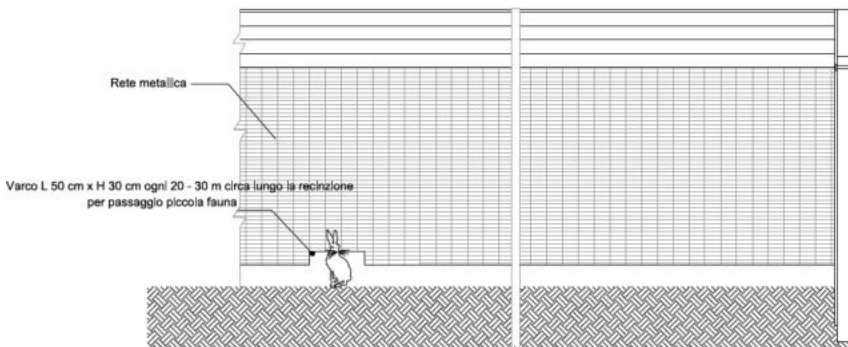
Opere di mitigazione – Particolare recinzione con passaggio piccola fauna
